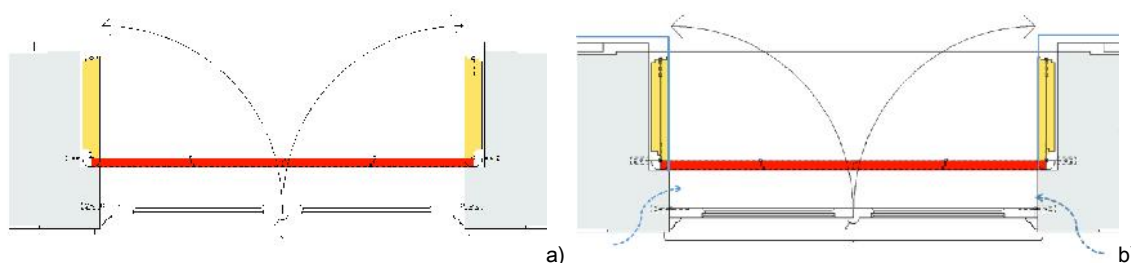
a) Contraventanas internas de madera abiertas (amarillo) y cerradas (rojo); b) Aislamiento de la pared interna y riesgo de puente térmico (azul).⁶
